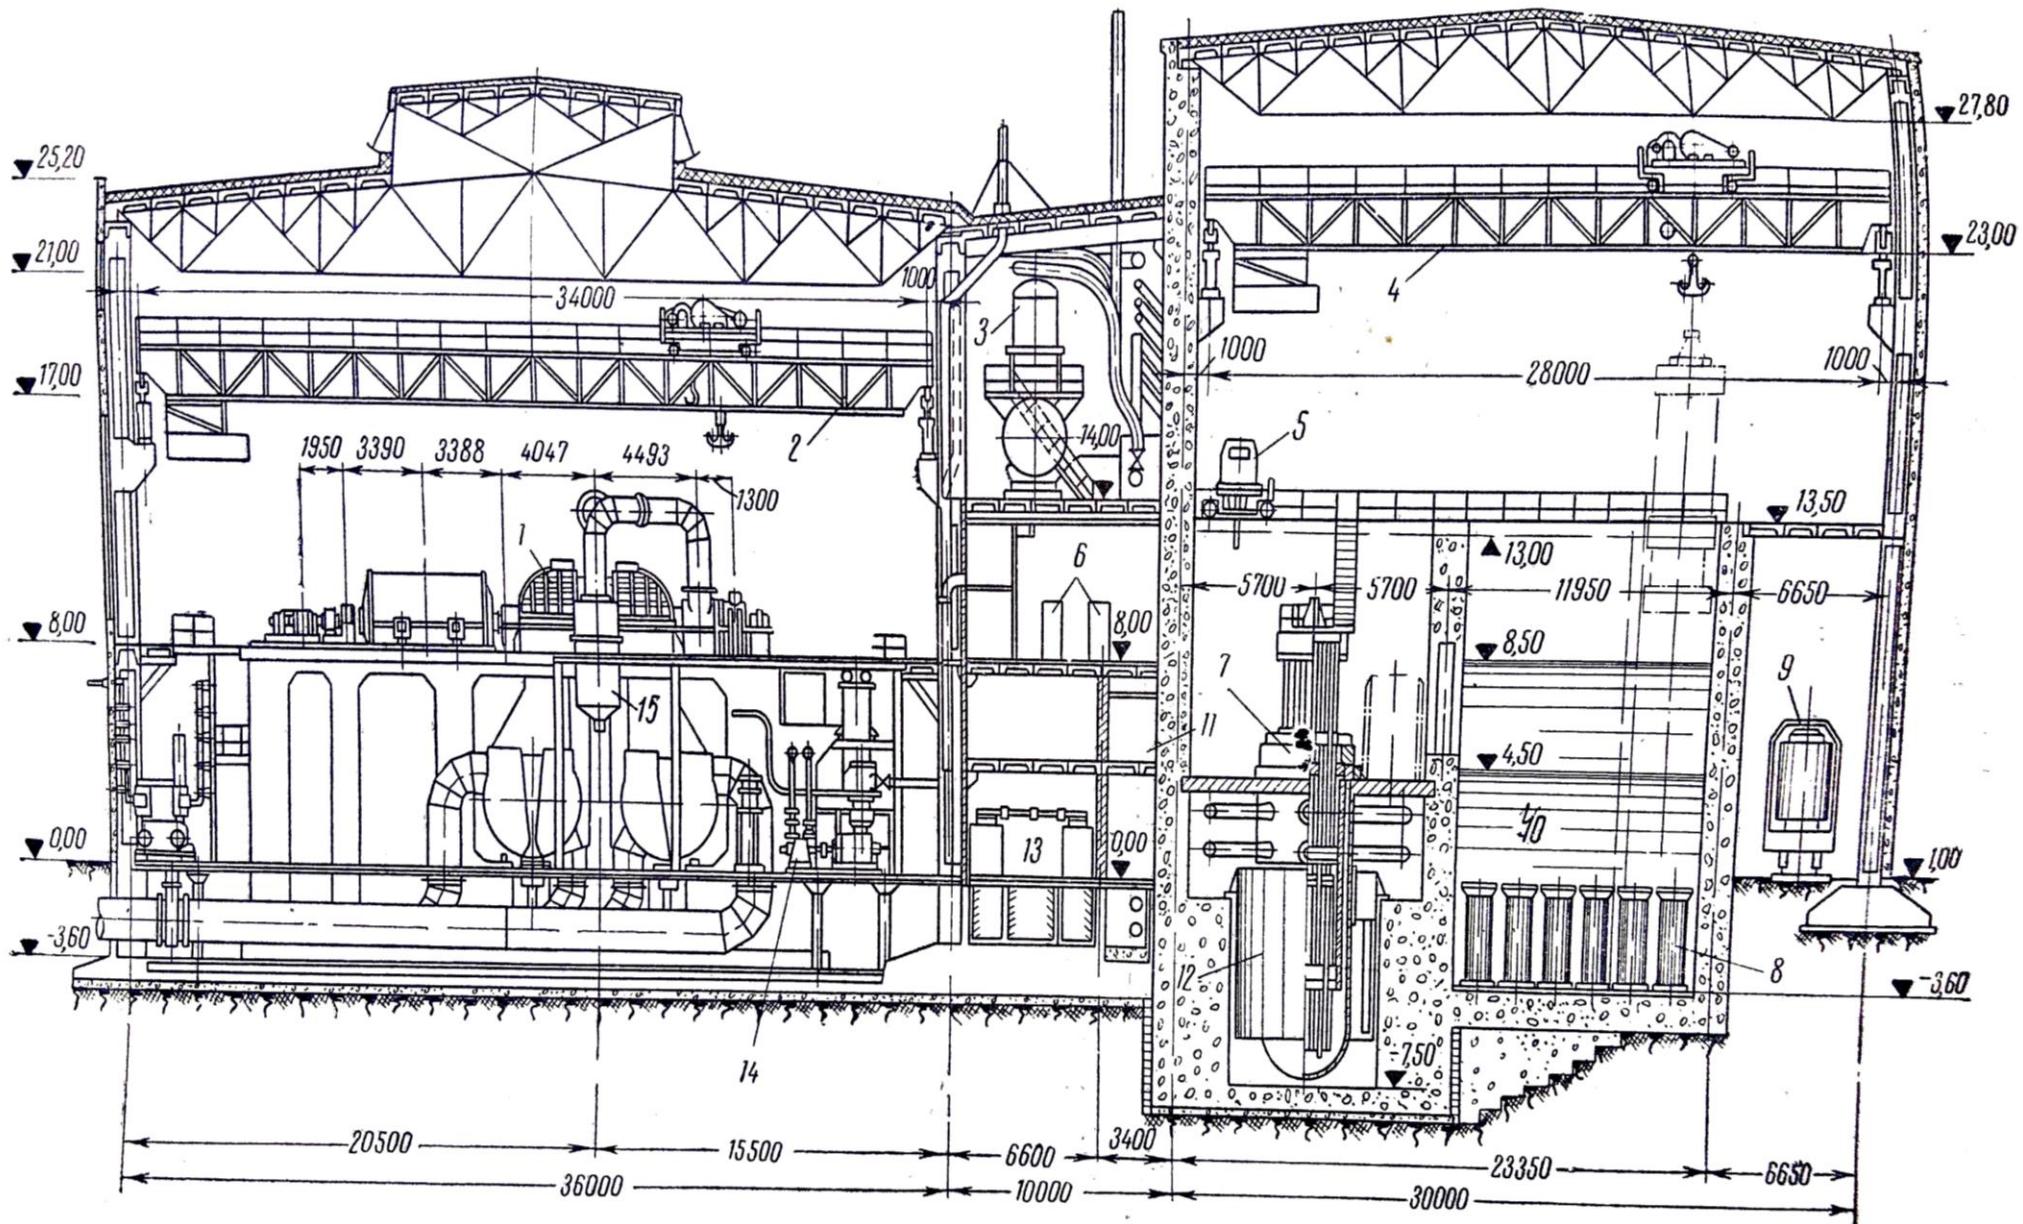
Сомкнутая компоновка главного корпуса двухконтурной АЭС (поперечный разрез).
